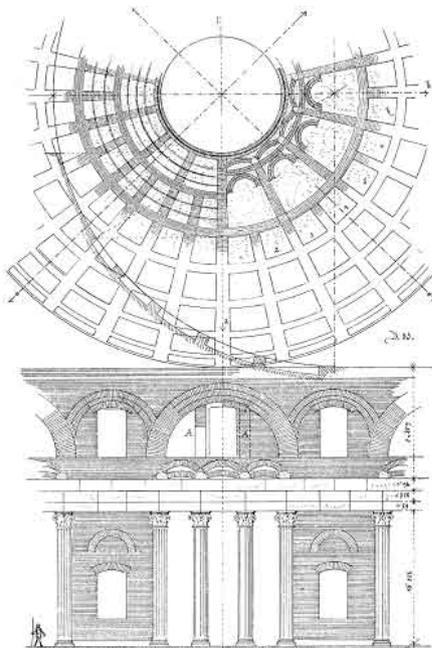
Planta y sección del Panteón, Roma, Italia. (Opus caementitium)
